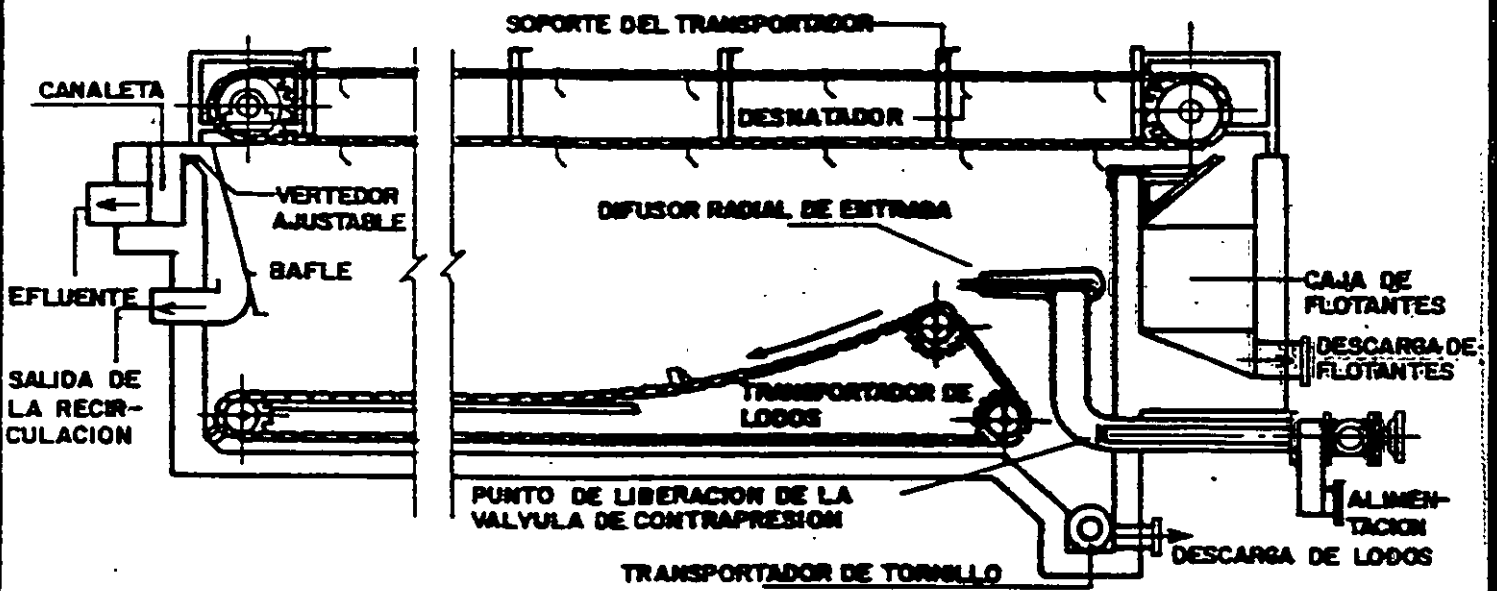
TANQUE DE FLOTACION - SECCION RECTANGULAR ESTRUCTURA DE CONCRETO REFORZADO
